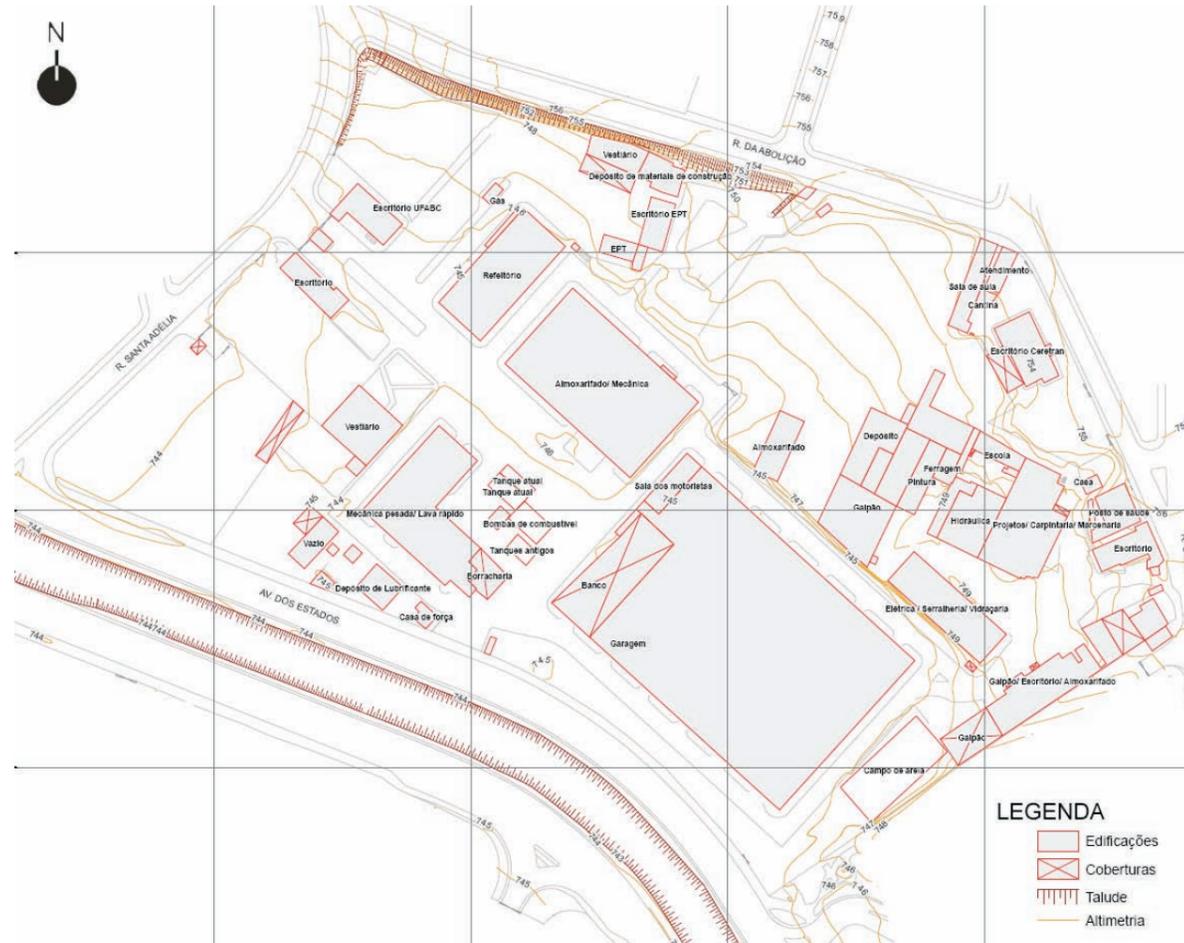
Planta de 'Ocupação da área pela Secretaria de Obras PMSA'
